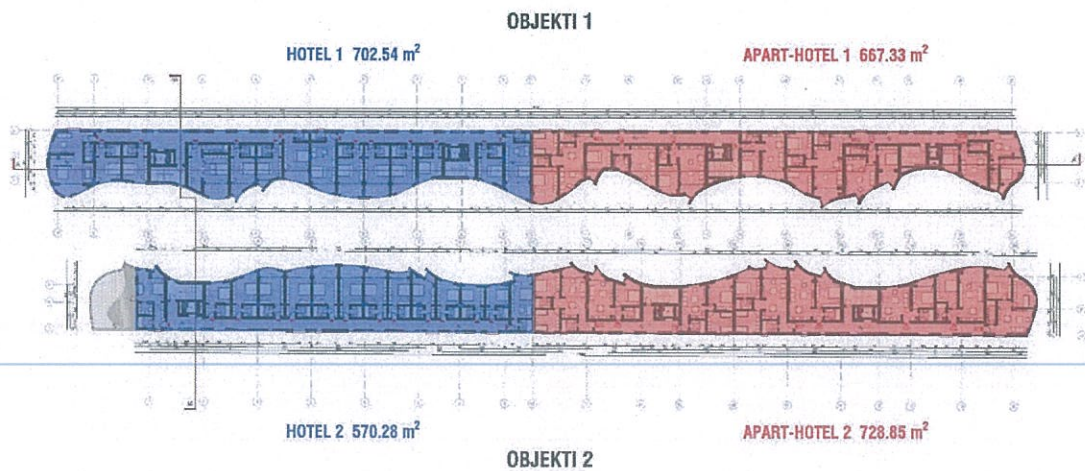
Planimetria e Katit të Dytë \_HOTEL DHE APART - HOTEL
